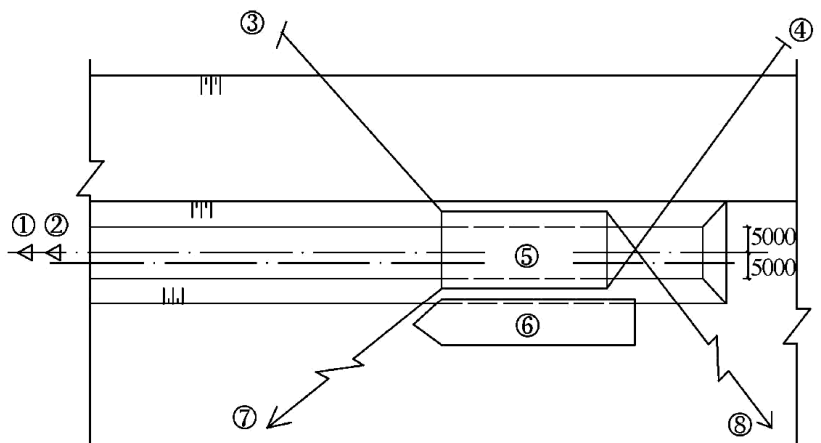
抓斗船开挖基槽示意图(尺寸单位: mm)
